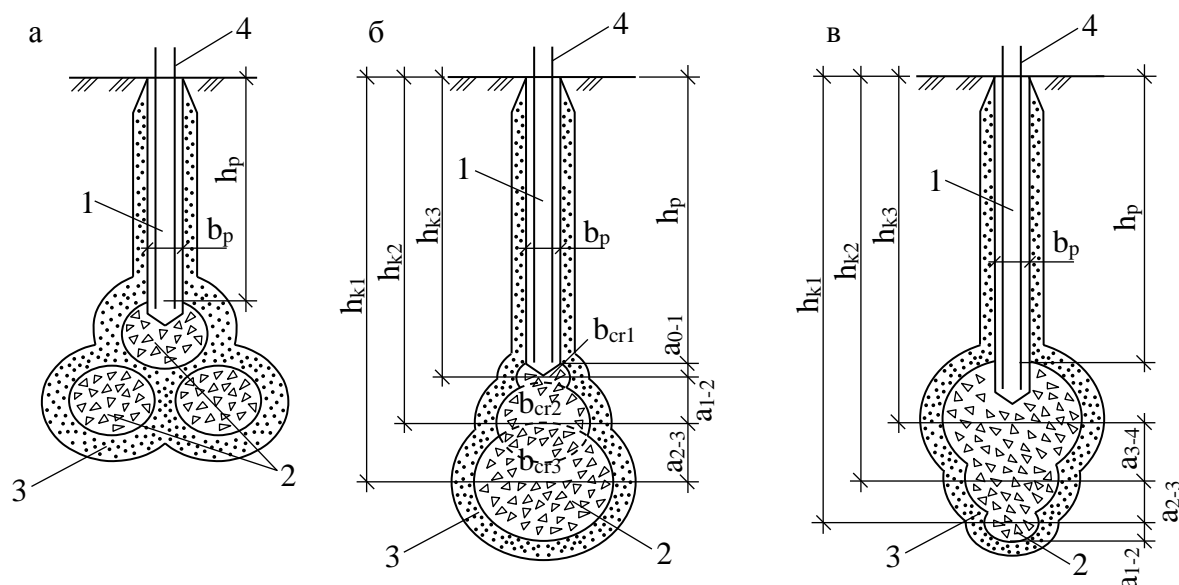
Фундаменти в пробитих свердловинах із розвиненими розширеннями: 1 – стовбур фундаменту; 2 – розширення з жорсткого матеріалу; 3 – ущільнений ґрунт; 4 – арматура
